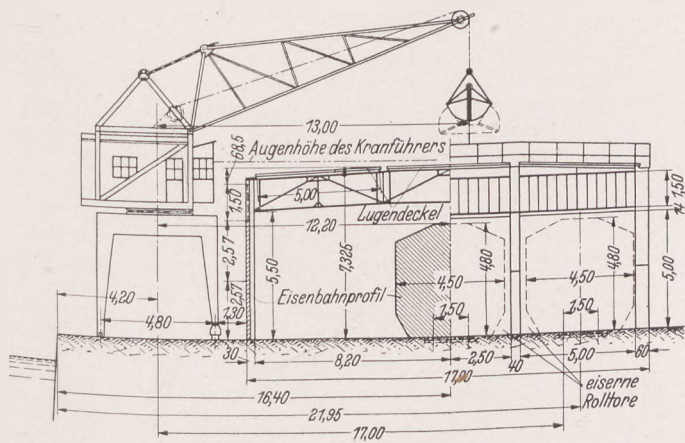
Querschnitt und Seitenansicht des Kaischuppens.
